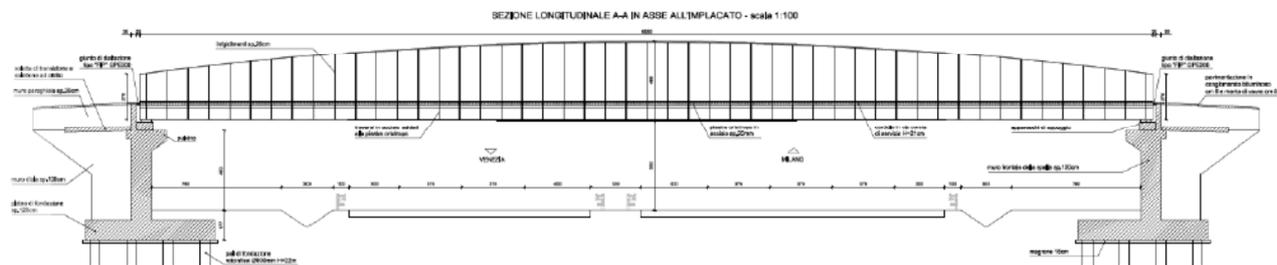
Sezione longitudinale del sovrappasso (Fonte: Lista di controllo)
